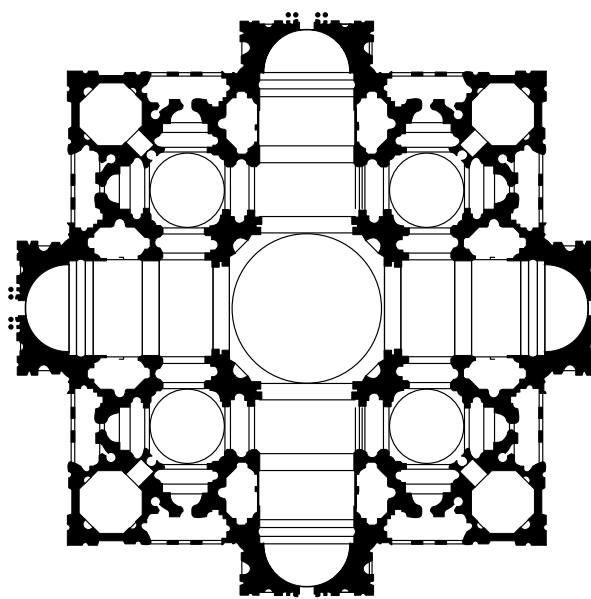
Roma, Pianta di San Pietro secondo Bramante.
